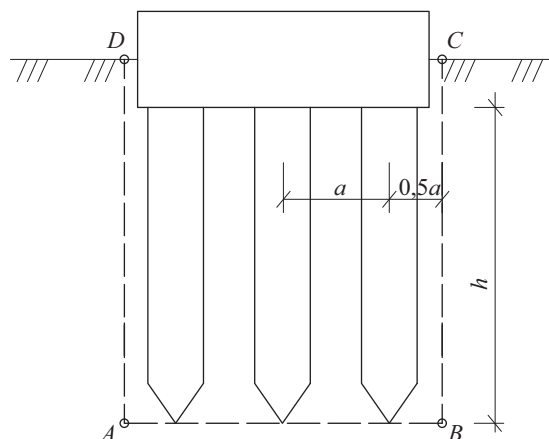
Условный фундамент для расчета осадки условного свайного фундамента по контуру ABCD в соответствии с СП 24.13330.2011
